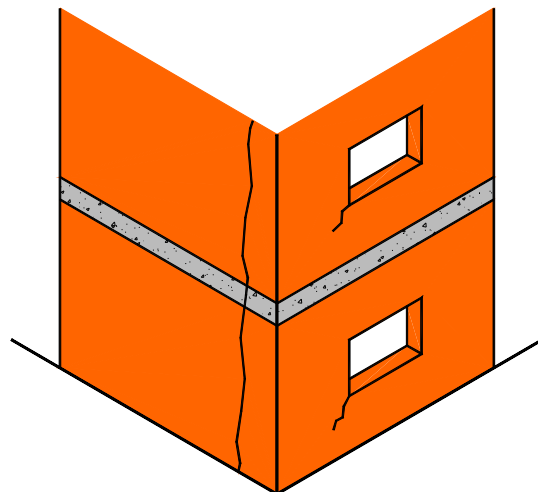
Fissuração vertical da alvenaria no cunhal da obra provocada por movimentações higroscópicas [30]
